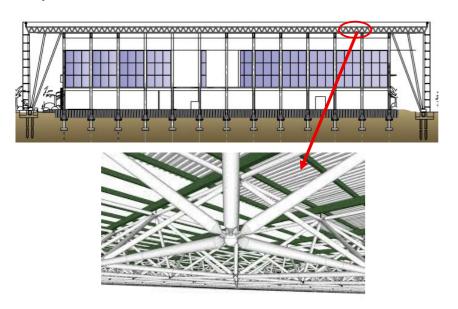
Konsep Supper Struktur 2 Bangunan
